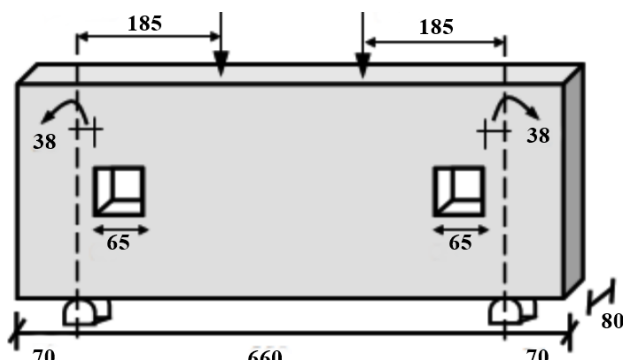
Geometria, carregamento e dimensões das aberturas das vigas-parede (mm) (ABDULJALIL, 2014).
